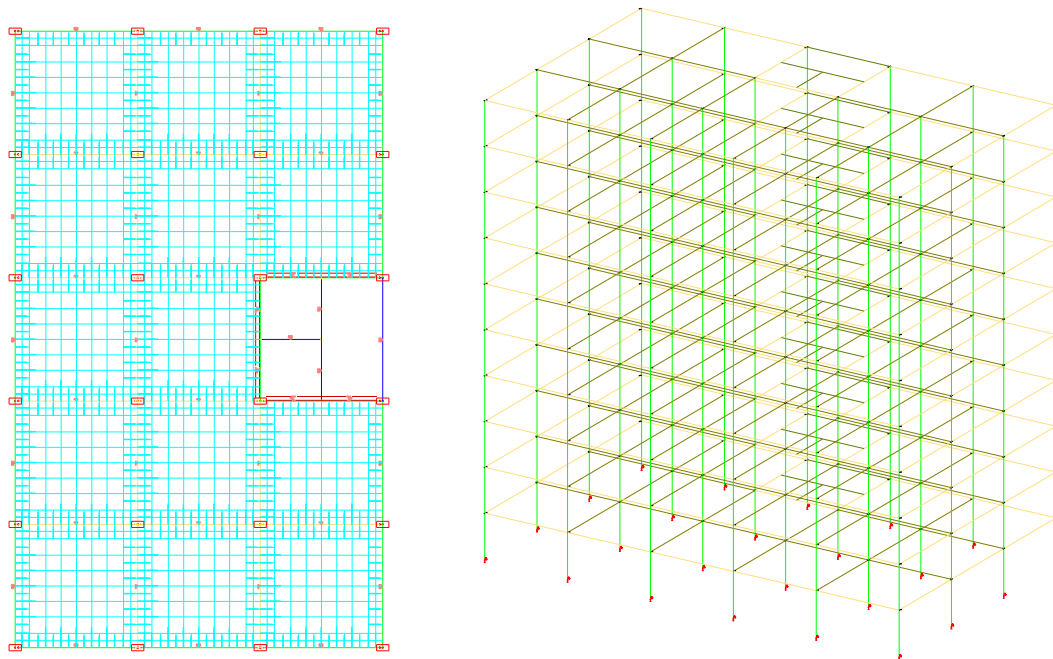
Pavimentos discretizado por grelha de lajes nervuradas e pórtico espacial.
